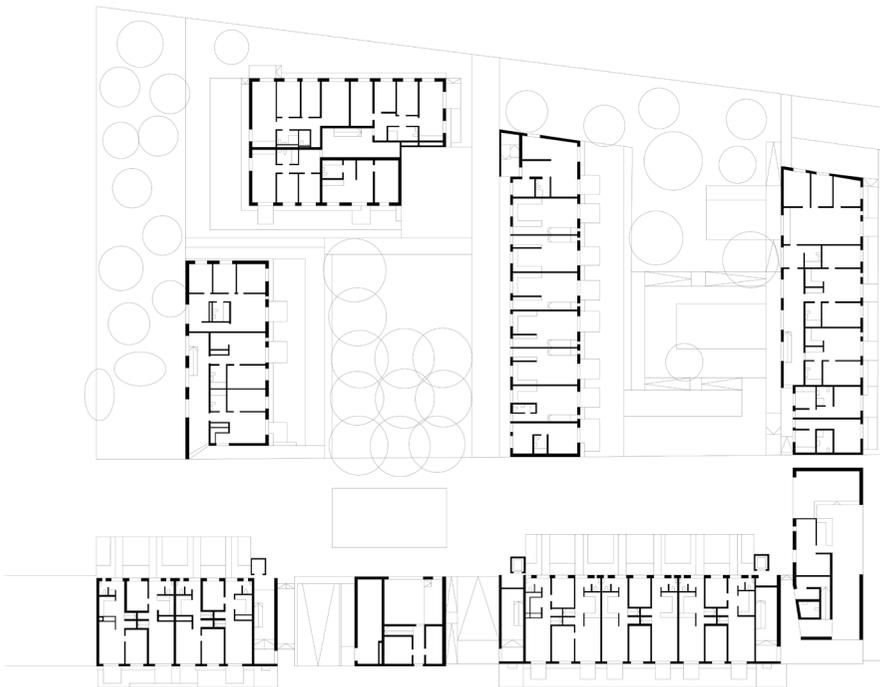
Wagnis 3, Grundriss EG mit Hof
